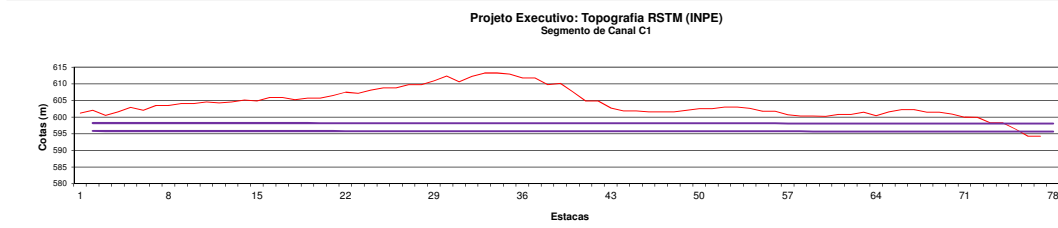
Perfil longitudinal – Segmento de Canal C1 – Traçado executivo (RSTM/INPE)
